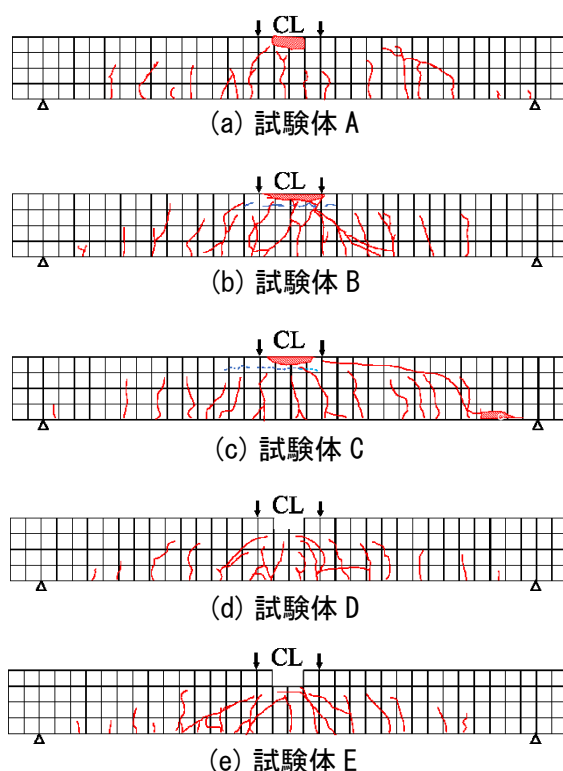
曲げ試験終了後のひび割れ発生状況
